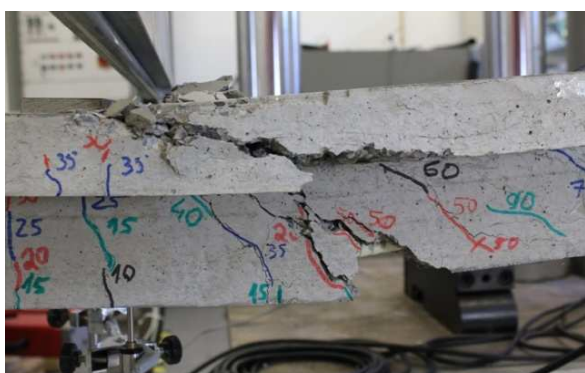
Rotura por esmagamento do betão no vão da viga G3-a
